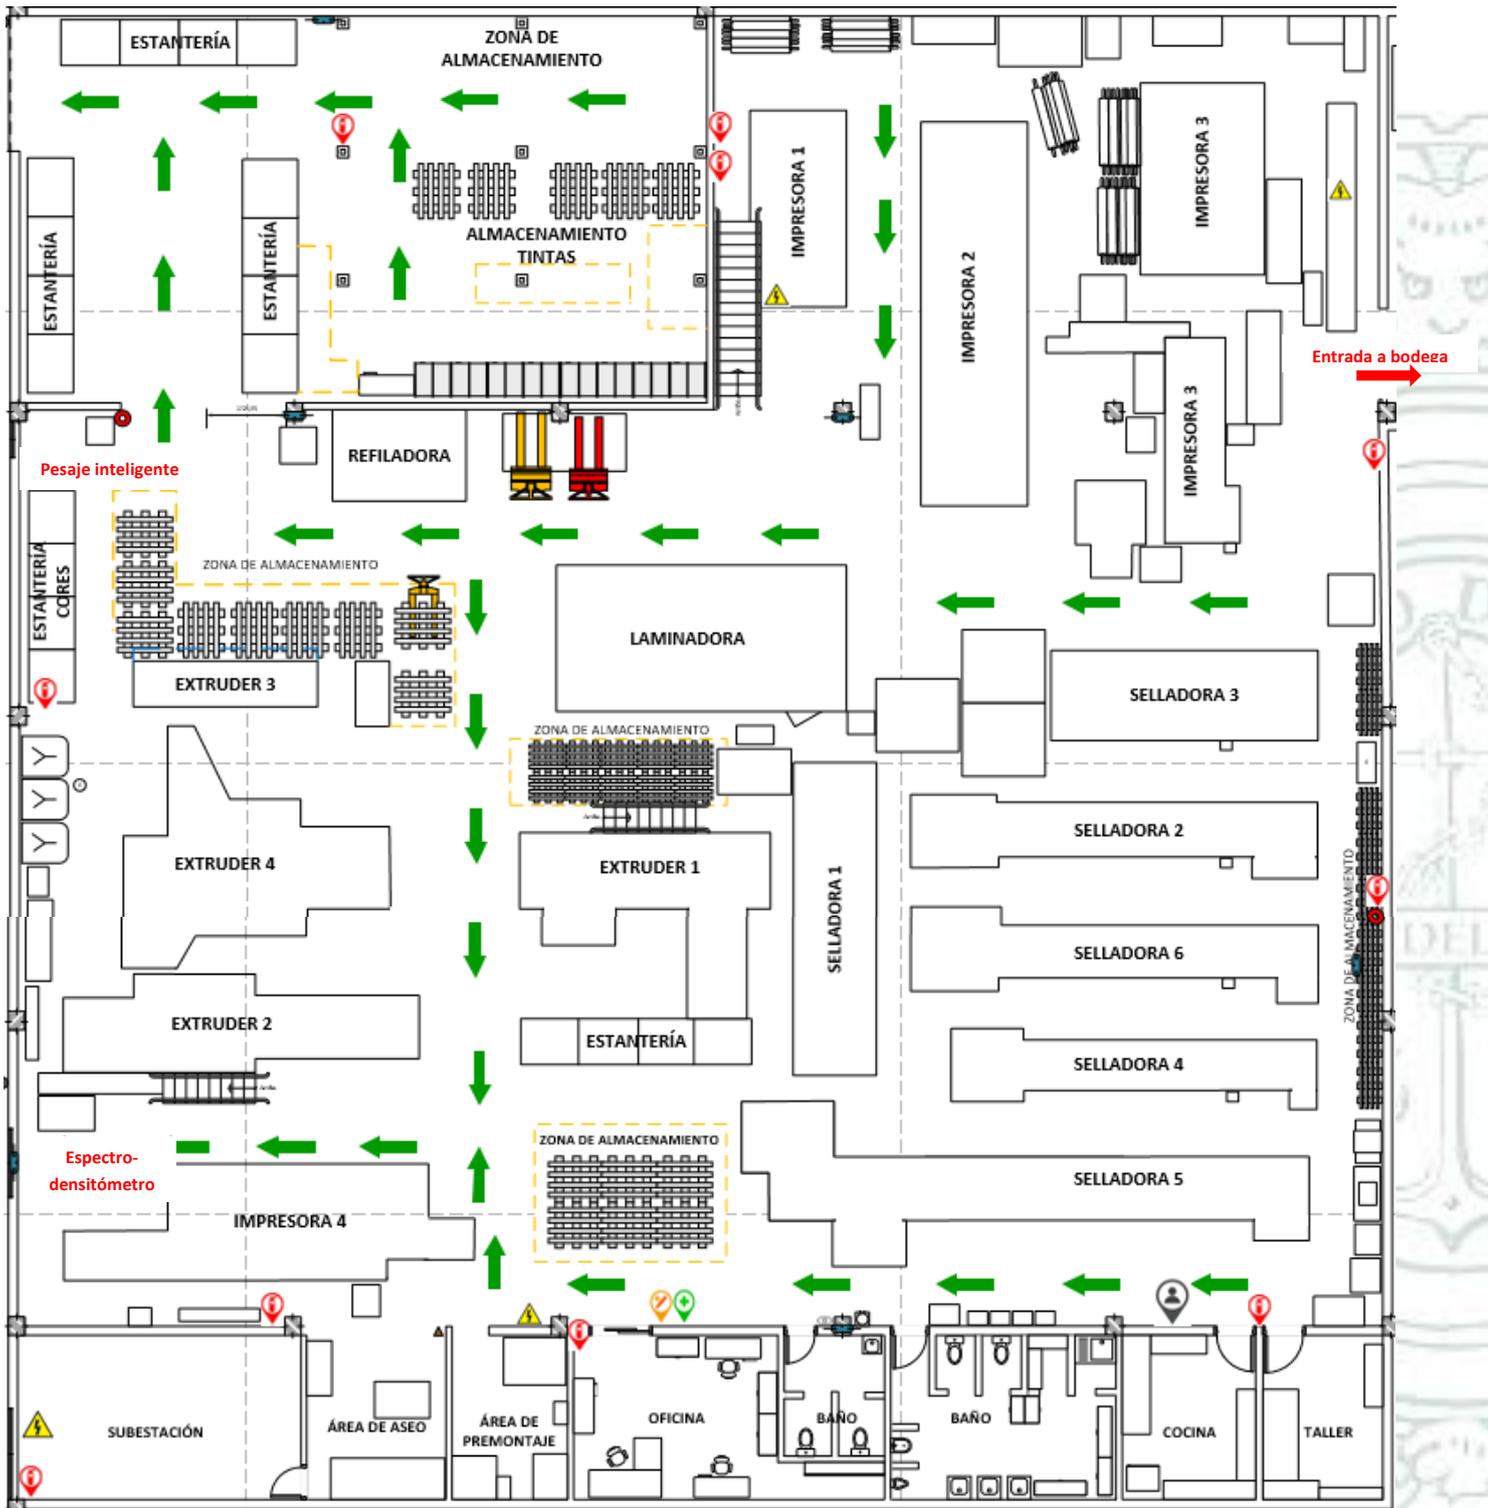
Plano de evacuación de la planta de producción de la empresa Plásticos G&C S.A.S.
